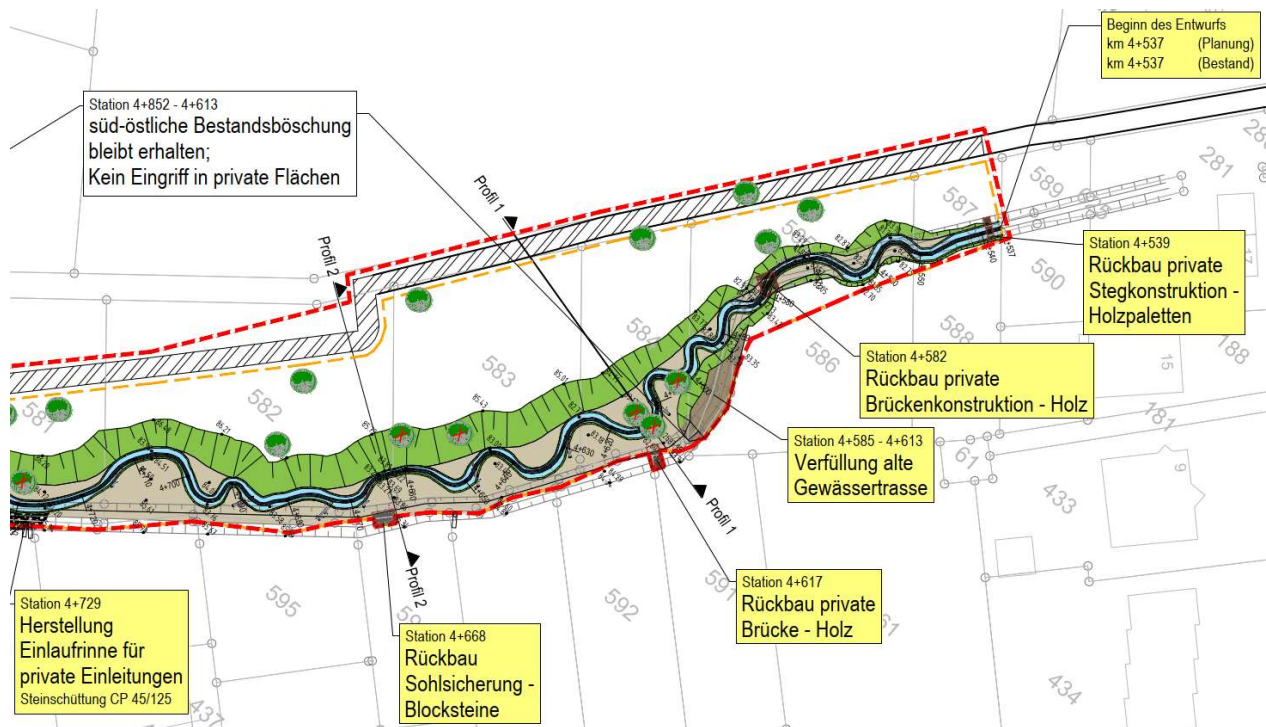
Geplante Maßnahmen zum Abschnitt 1 (Lageplan – Blatt-Nr. 03)
